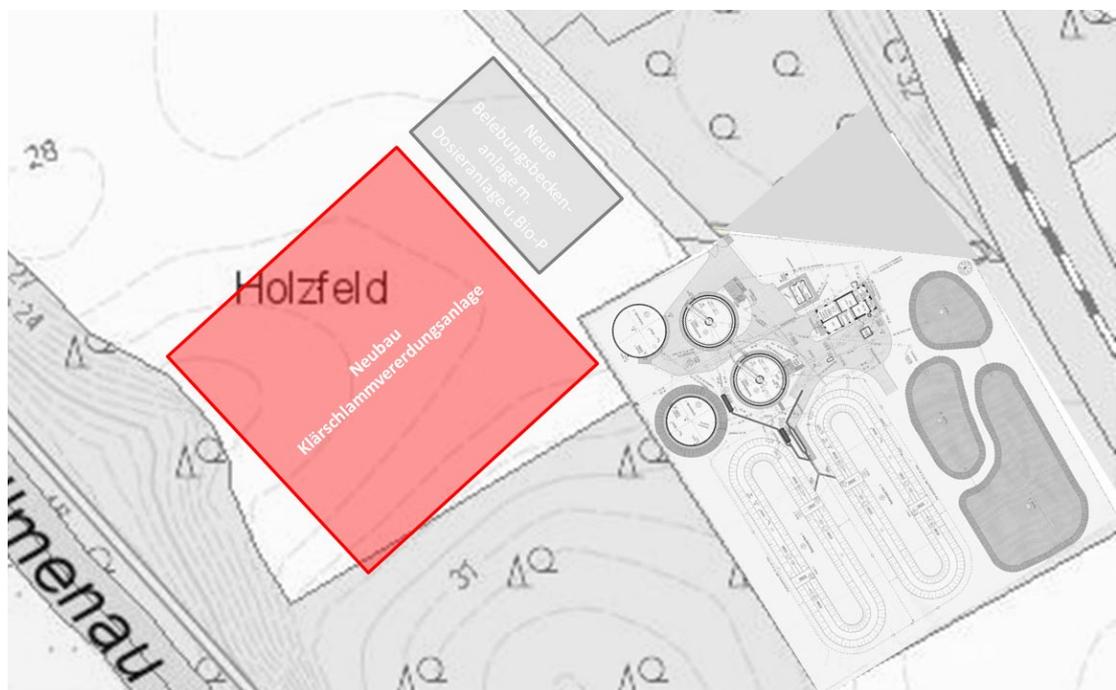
Lageplan der Kläranlage Bienenbüttel mit geplanten Maßnahmen 2
